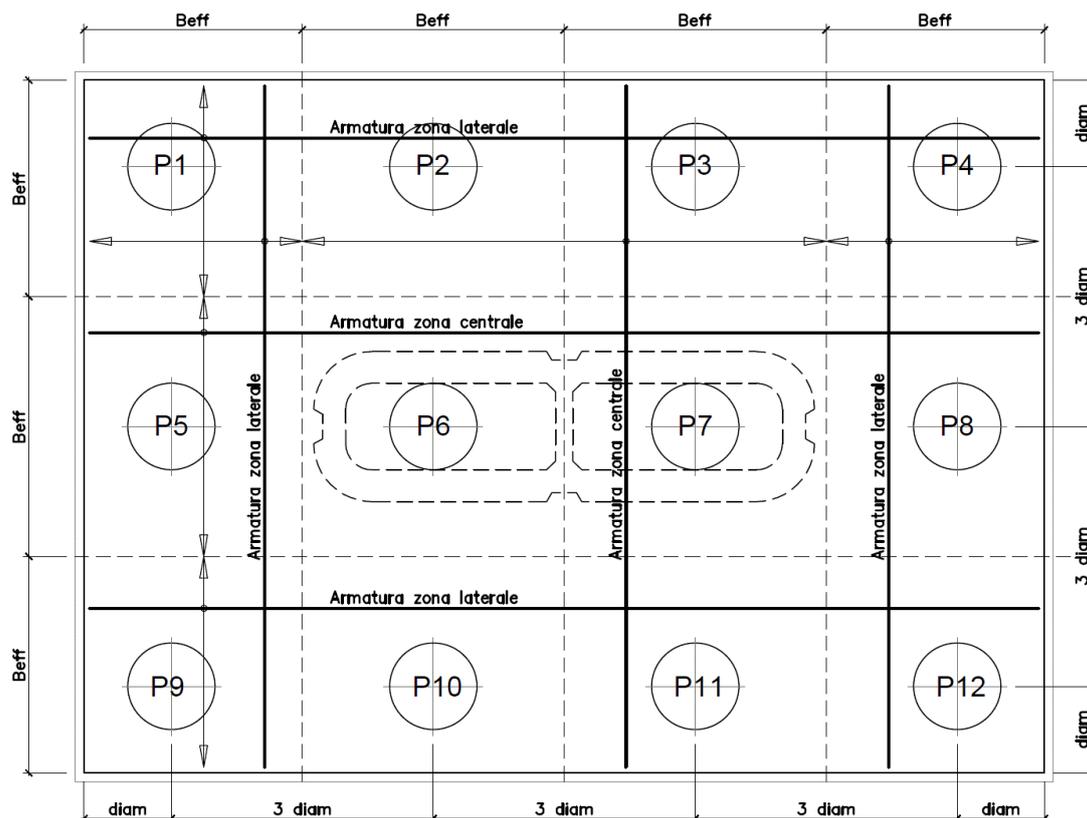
Plinto di fondazione – Armatura longitudinale inferiore e superiore
